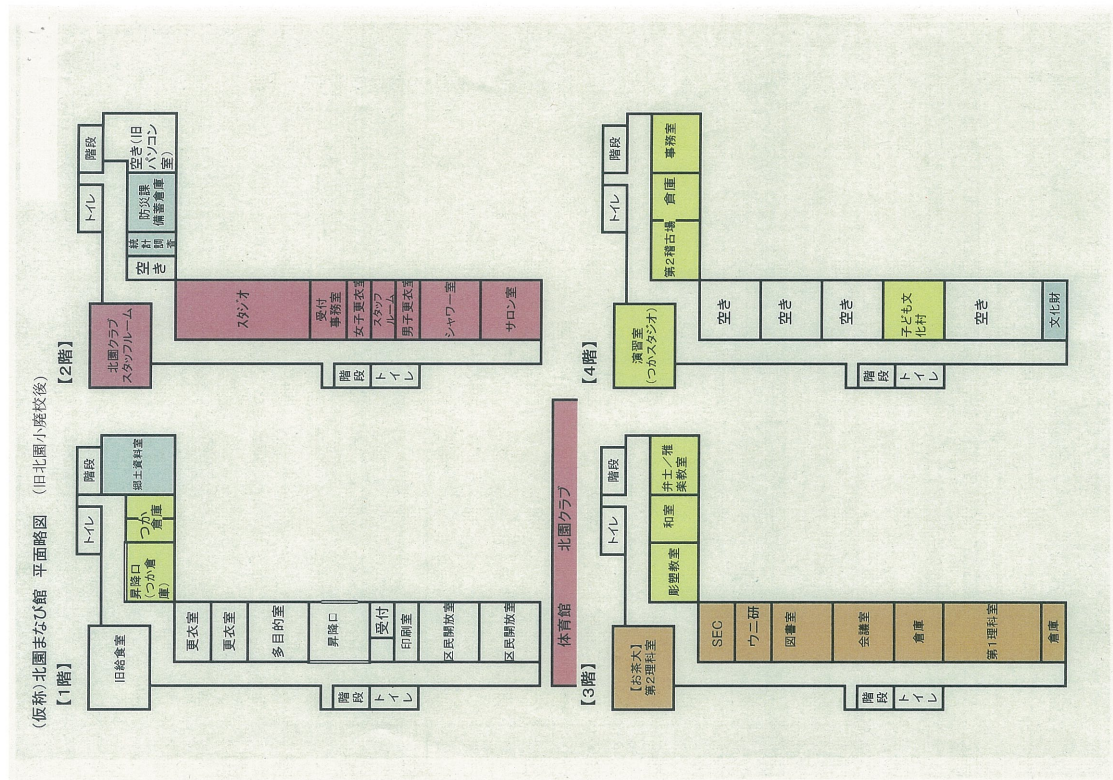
旧北園まなび館平面図 (参考文献 80 より転載)
